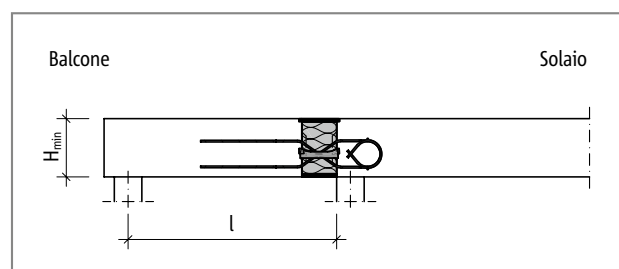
Schöck Isokorb® XT tipo QL-VV: schema statico (XT tipo QL-VV1 – VV4)
